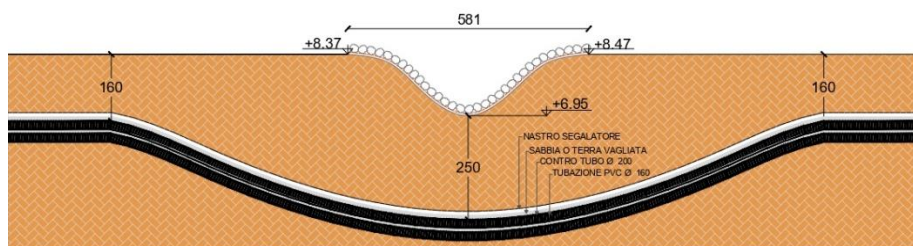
Sezione tipo dell'attraversamento del canale di scolo
